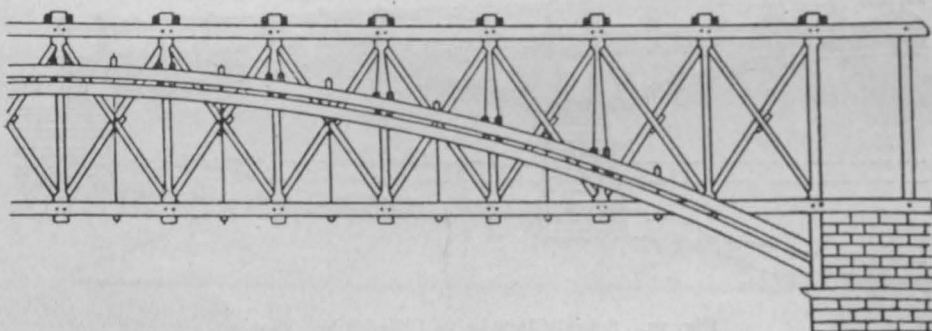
Brücke über den Connecticut bei Bellow Falls, 1804.
